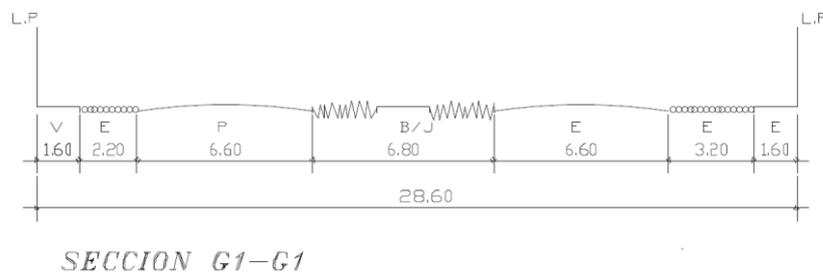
Sección vial según Plano de Esquema Vial - Fuente: Plano de Esquema Vial de Trujillo
